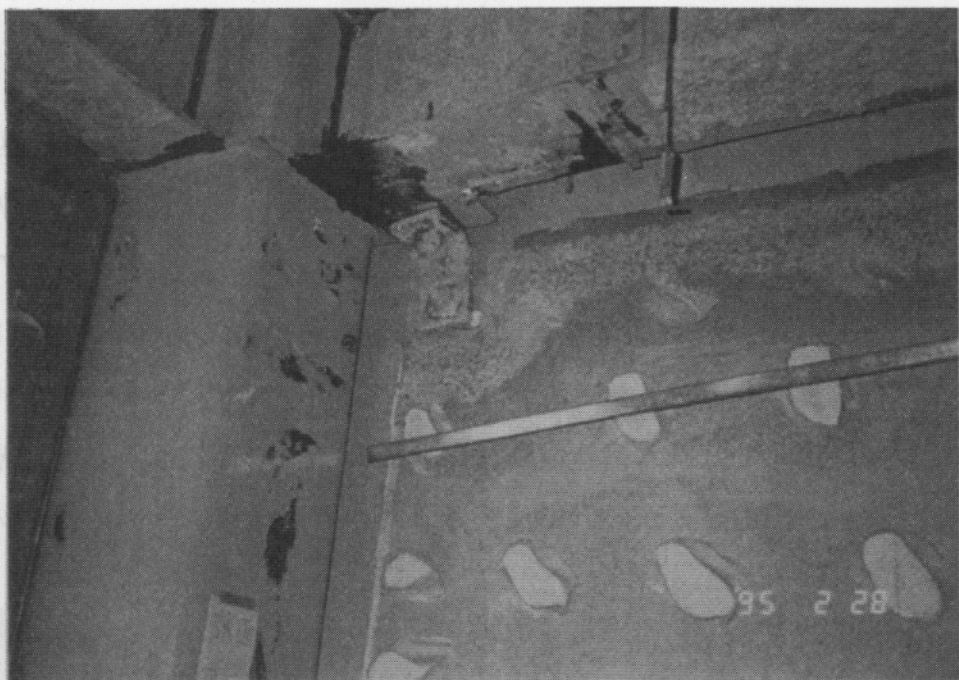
鉄骨造梁降伏例 (その1)
